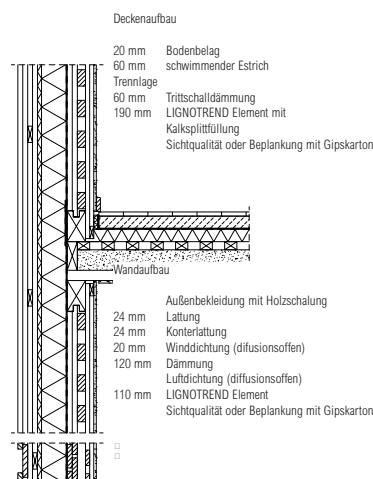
Anschlussdetail Wand - Decke, Lignotrend
